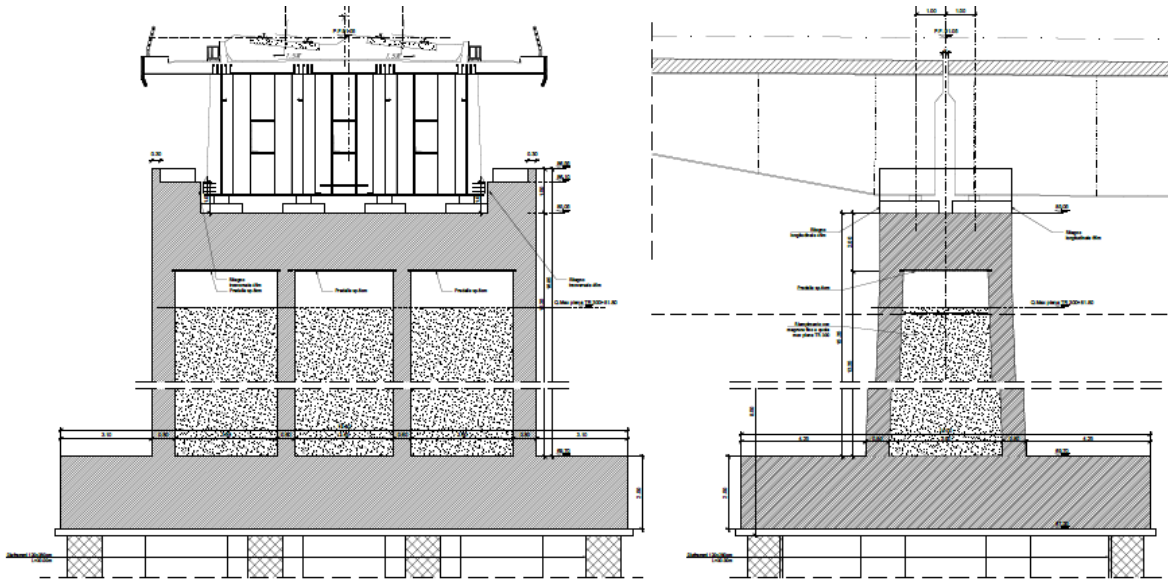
Sezione in direzione trasversale e longitudinale rispetto all'asse del viadotto P3
